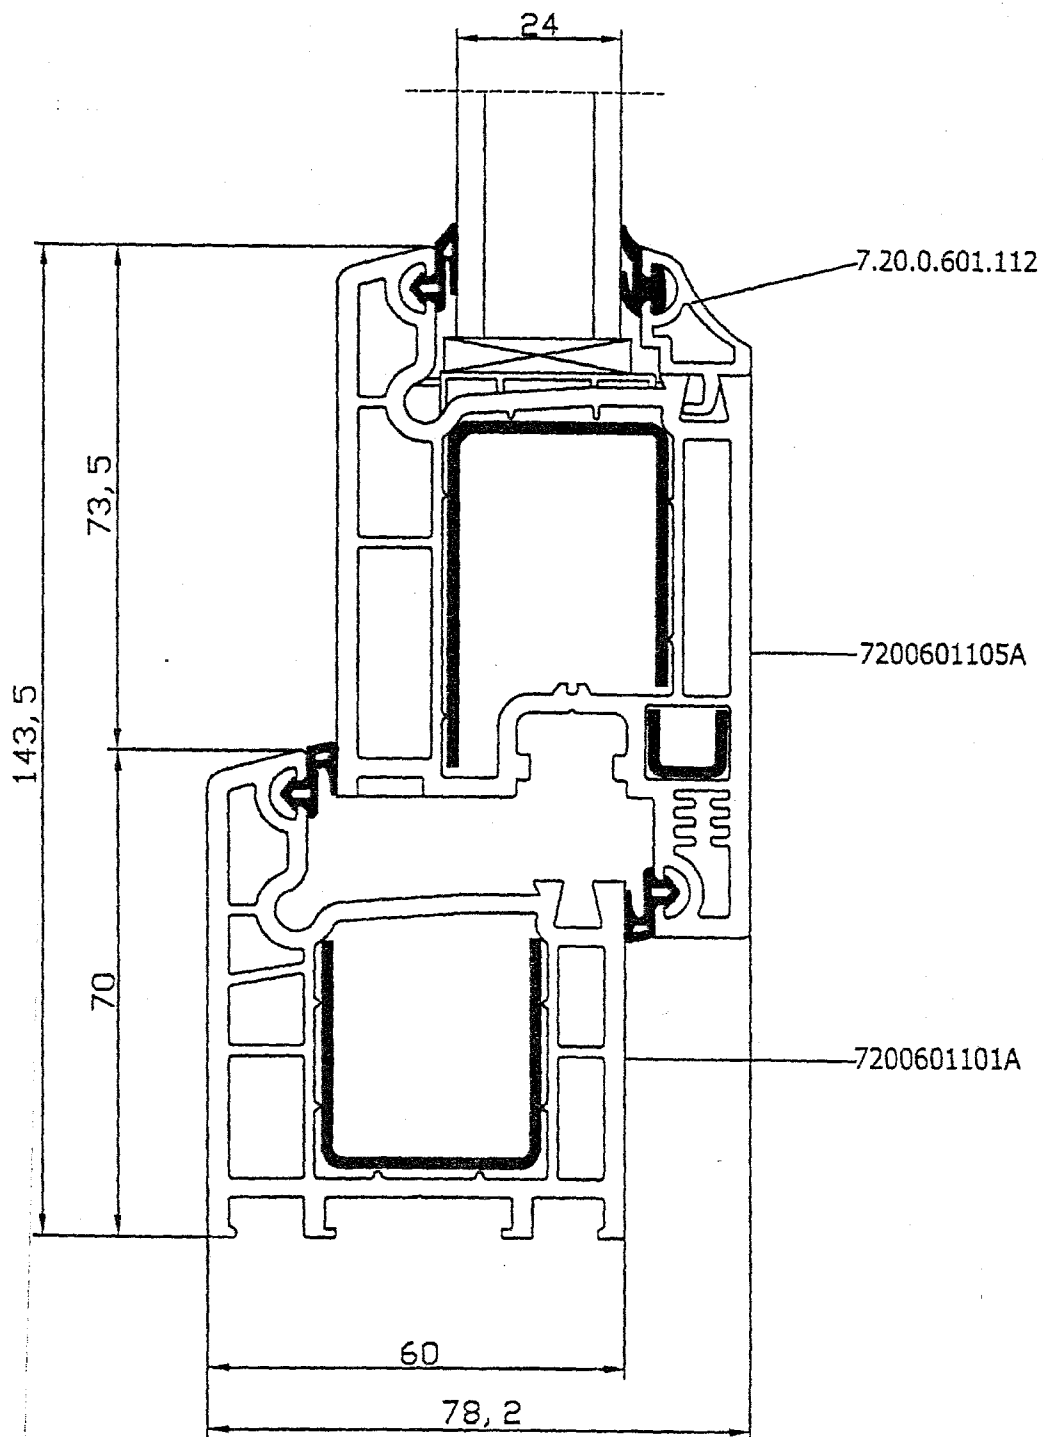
Przekrój przez ramę 7.20.0.601.101A okna stałego
